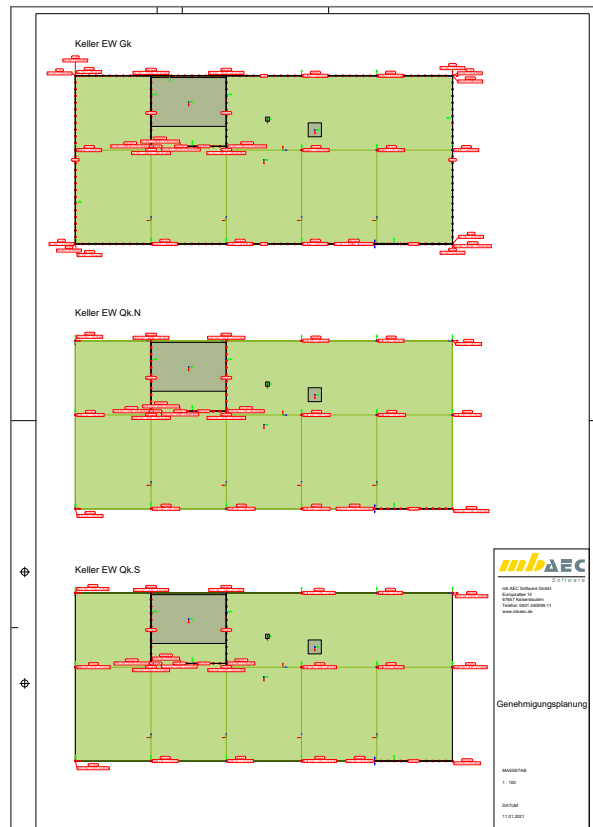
Beispiel einer Plansicht: Lasten auf eine Kellerdecke
